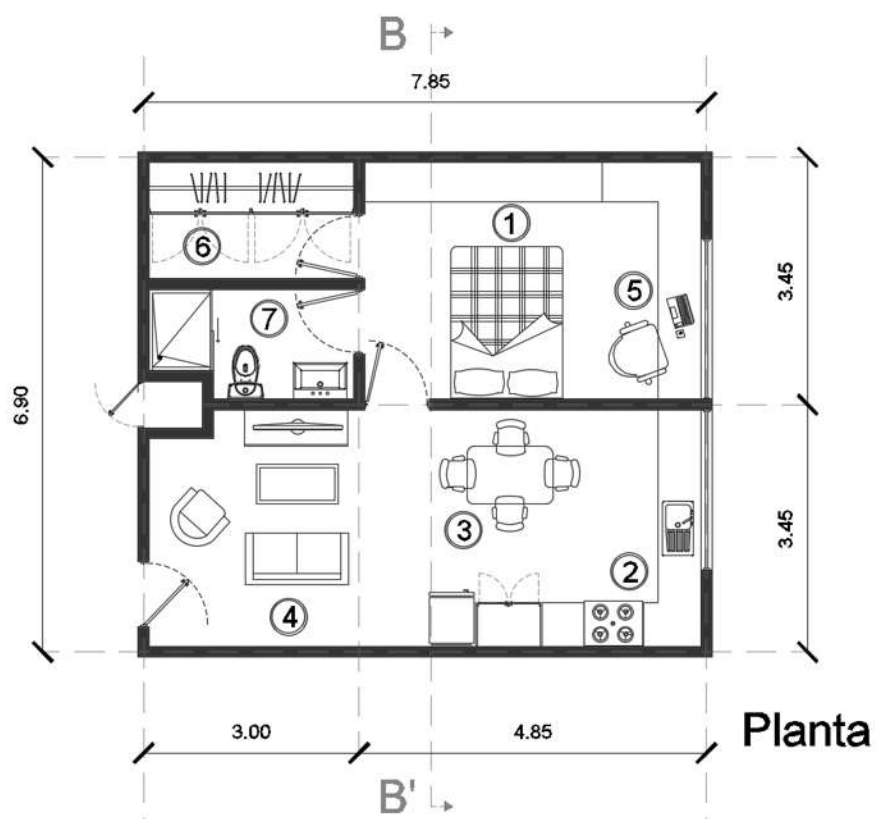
Vista en planta habitación tipo B. Fuente: Autor
